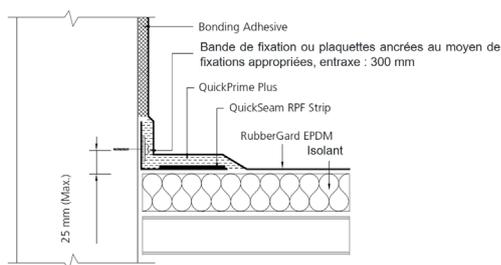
Fixation au droit de l'angle du relevé au moyen d'une bande QS FPF Strip
